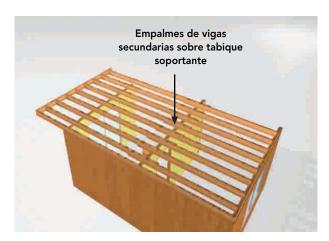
34 : Se ubican las vigas que conformarán la plataforma del entrepiso. Dichas vigas se traslapan sobre el tabique soportante separador.
